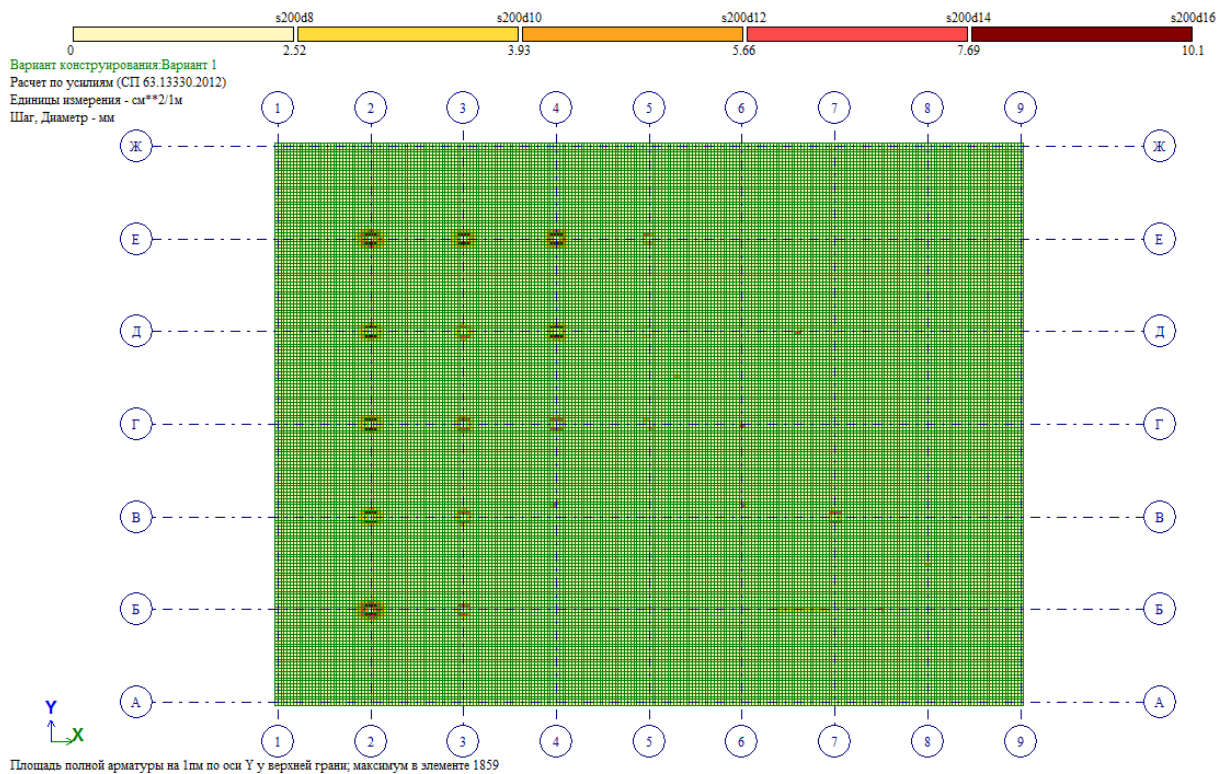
Верхнее продольное армирование по оси Y
